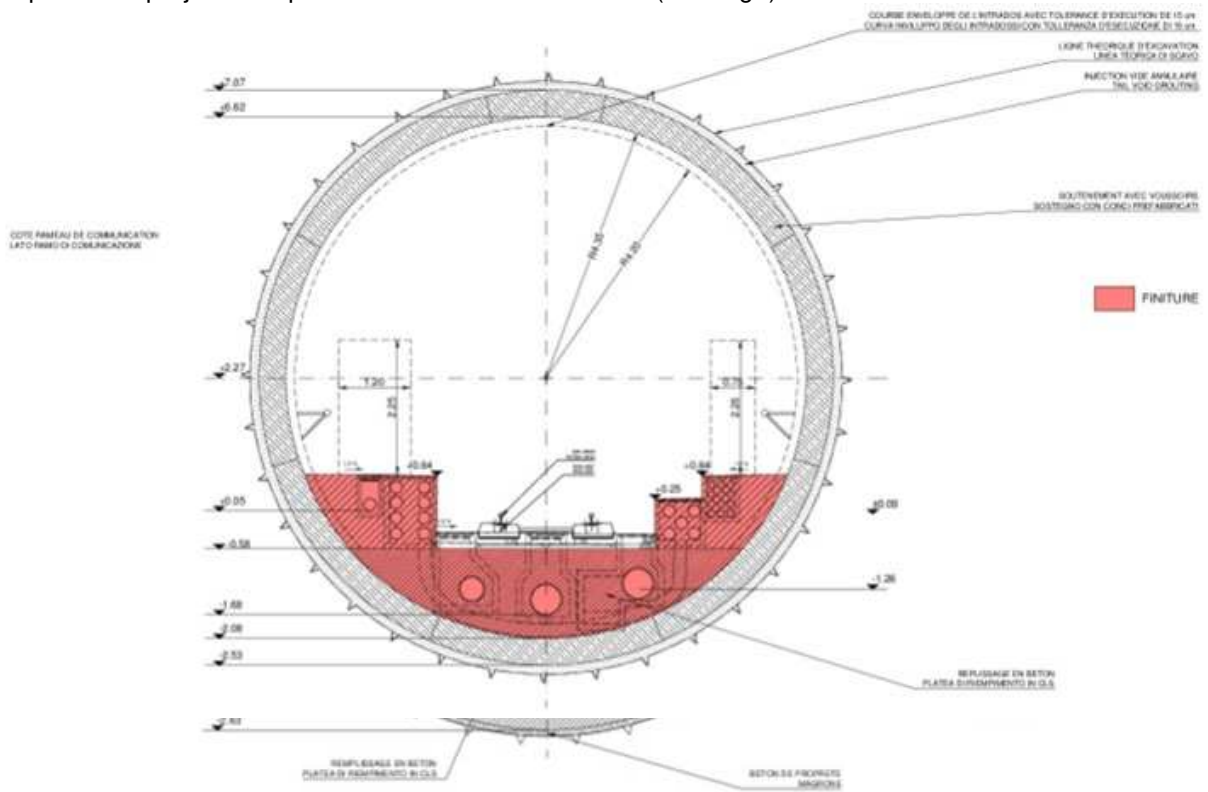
Tunnel de Base : section type descriptive de l’excavation par tunnelier à bouclier, sans drainage
